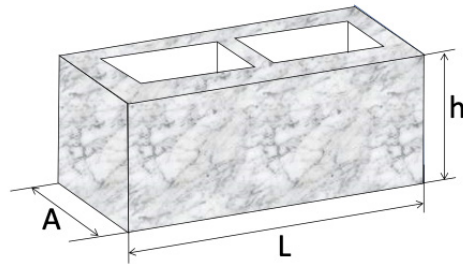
Forma prismática de la pieza. Fuente: Elaboración propia
